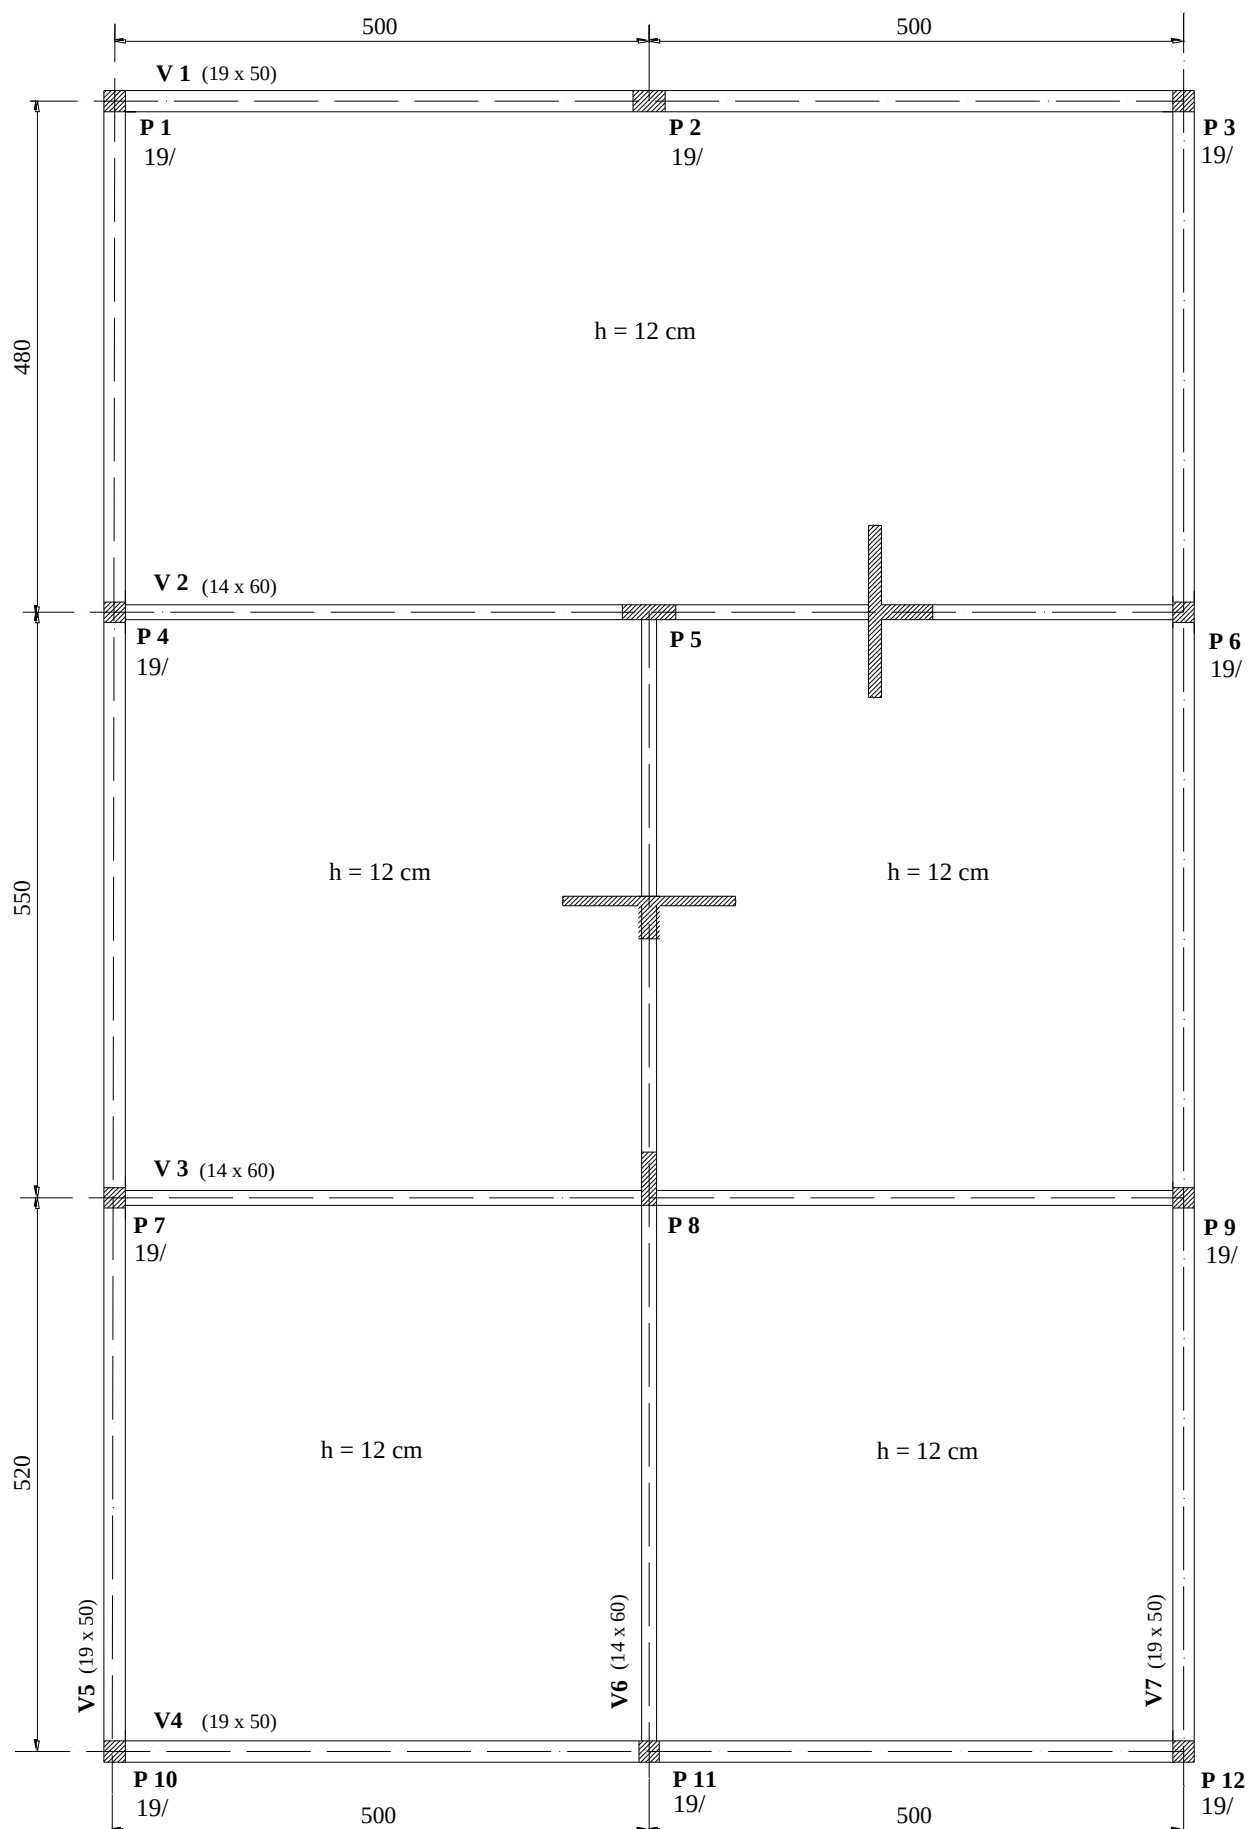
Planta de fôrma do pavimento tipo do edifício.
